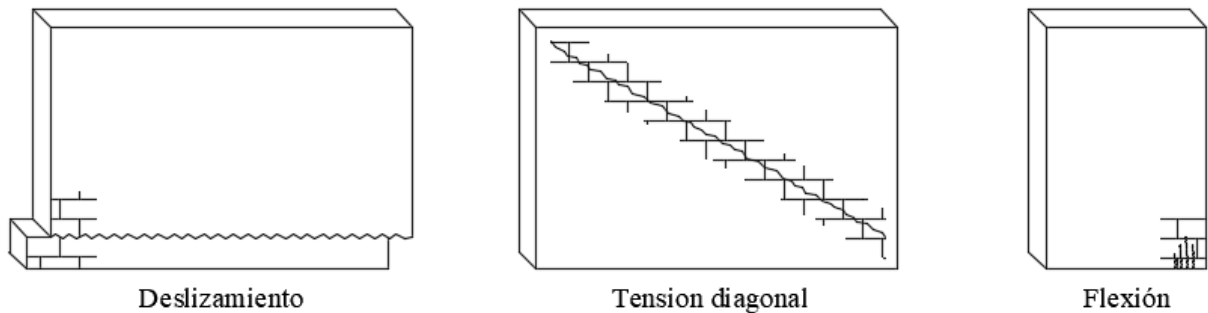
Mecanismos de falla en muros mampostería (Páez et al., 2009).
